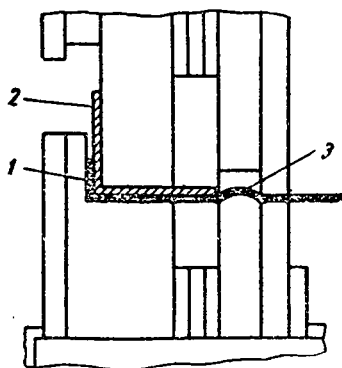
Схема офланцовки звена воздуховода уголко-вым фланцем на установке ВМС-57
